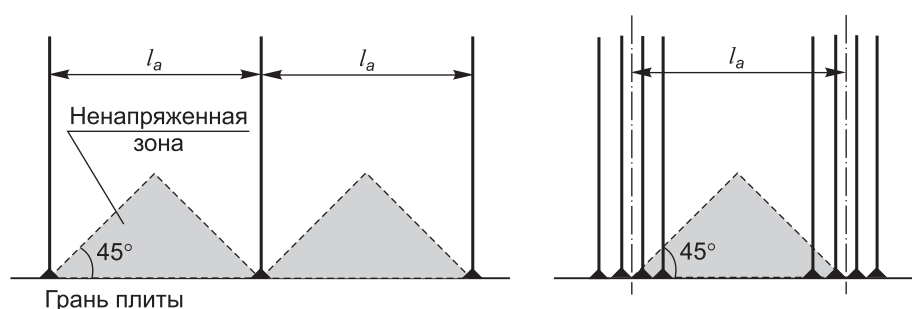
Схемы размещения ненапряженных зон в плоских плитах, в которых следует устанавливать дополнительную ненапрягаемую арматуру
